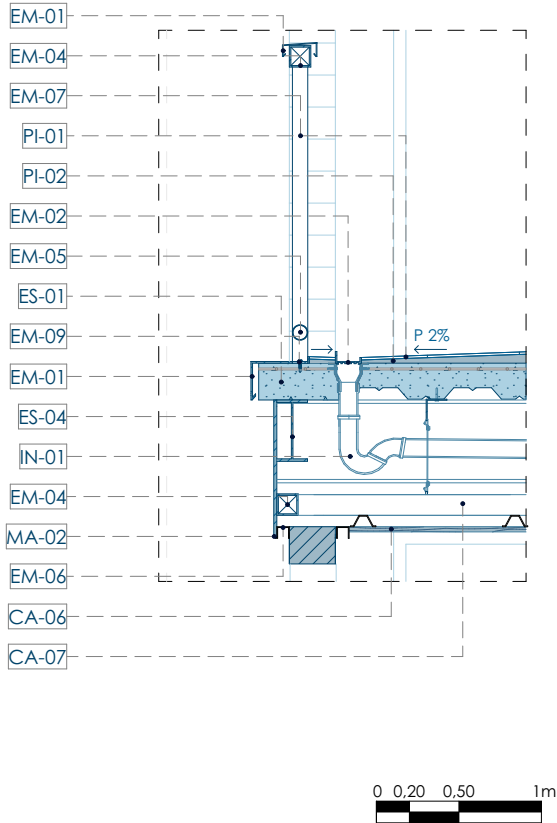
Detalle constructivo 03. Nota. Elaboración propia.
